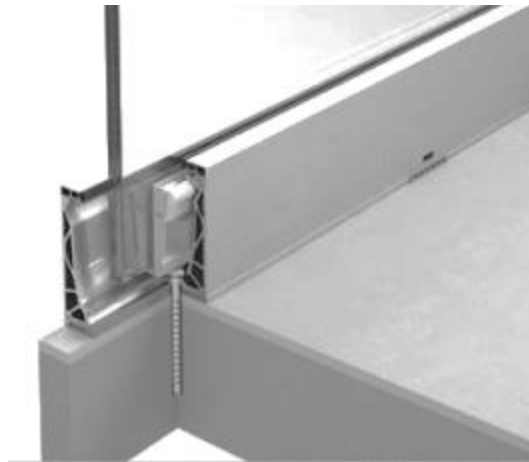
exemple d'installation avec drainage du profilé et de la dalle
